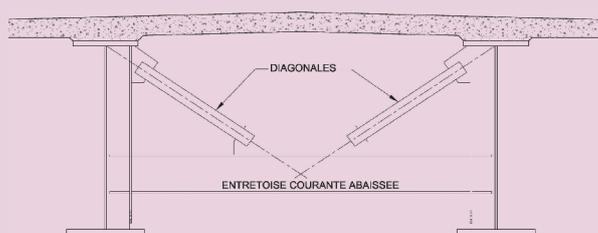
Entretoise courante abaissée et renforcée par deux diagonales
